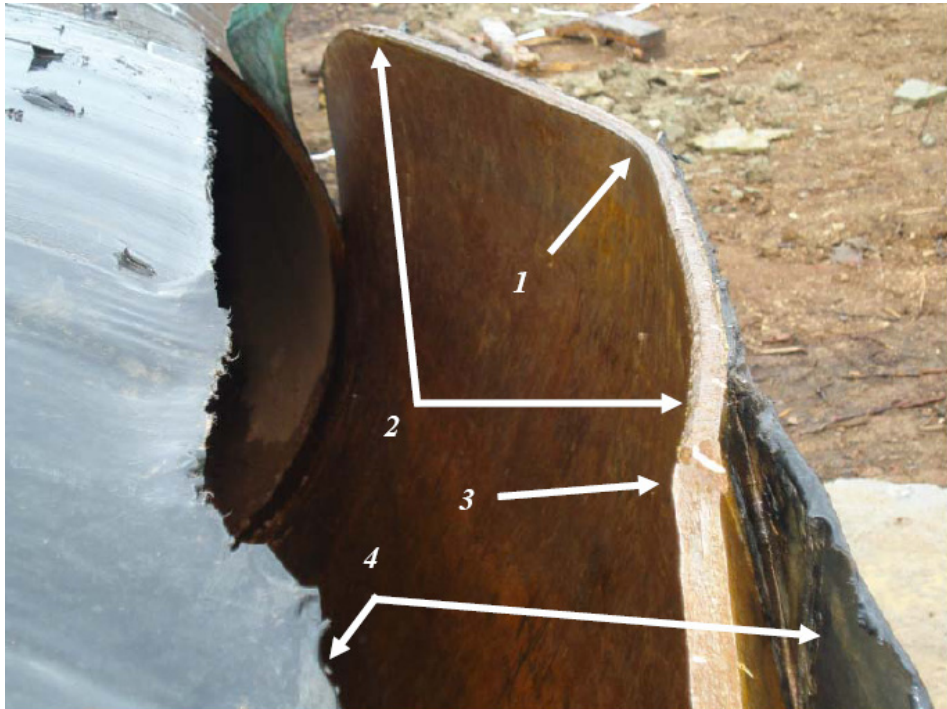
Вид сбоку разрыва трубы при гидроиспытаниях: 1 – место начала разрыва трубы, 2 – продольный сварной шов, 3 – кольцевой (монтажный) сварной шов, 4 – наружная изоляция трубы
